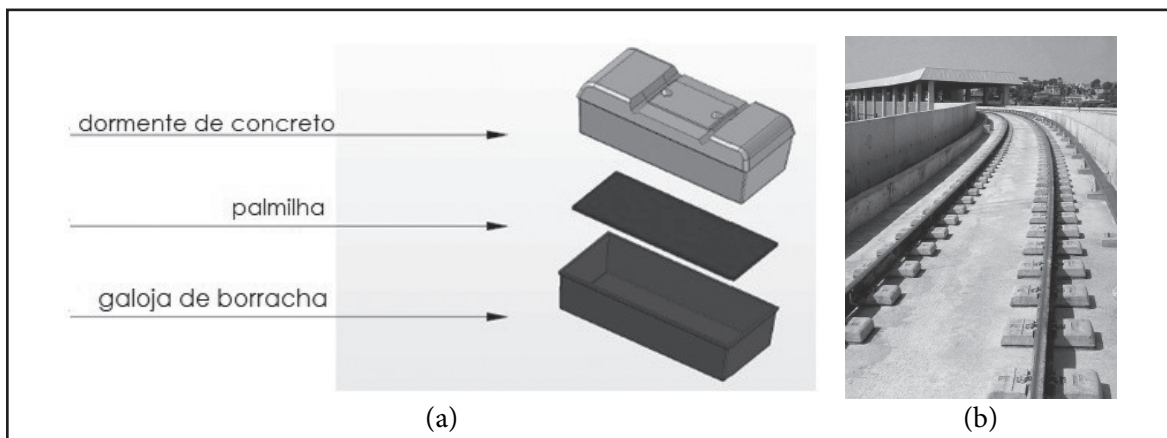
Esquema de montagem do sistema LVT (a) e foto da via férrea elevada (b)
